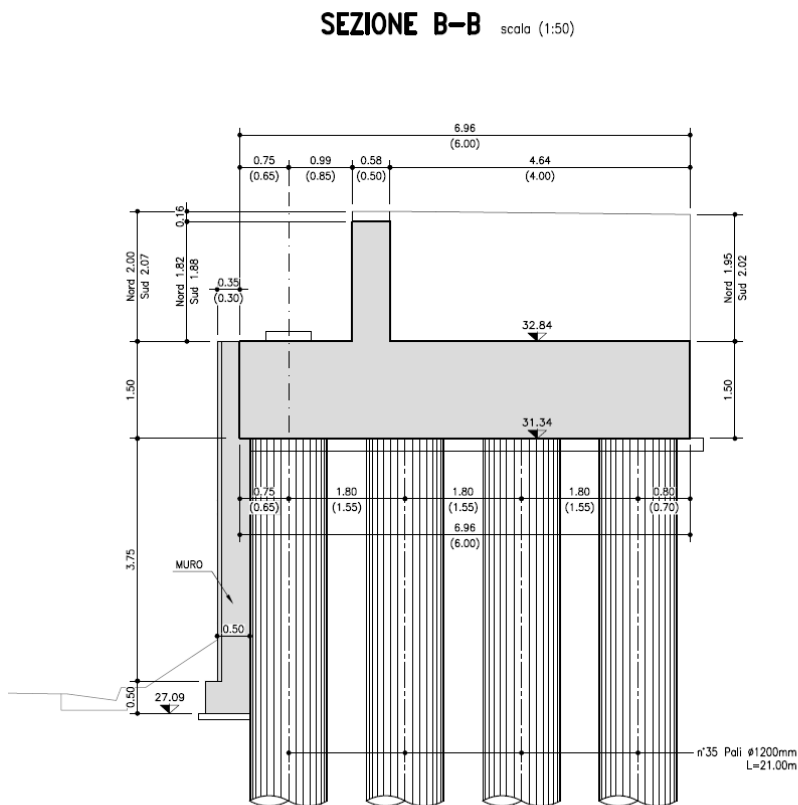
Sezione trasversale della Spalla B
